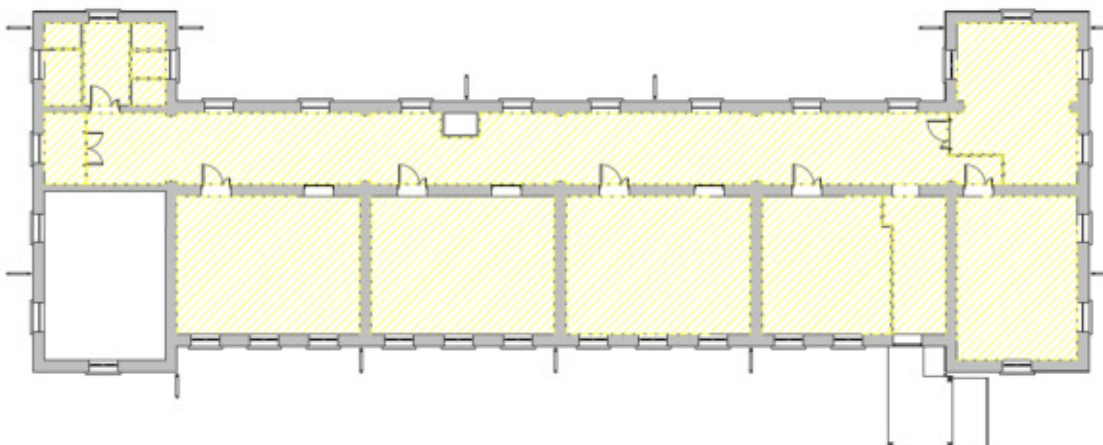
Pianta piano primo – Indicazione controsoffitti da sostituire
